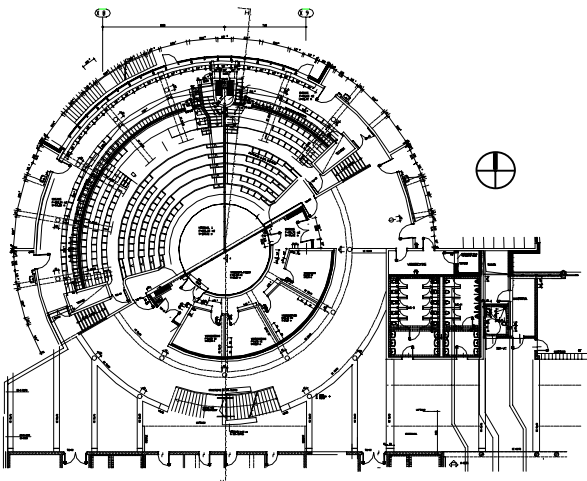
Grundriss (Maßstab ca. 1:600)
